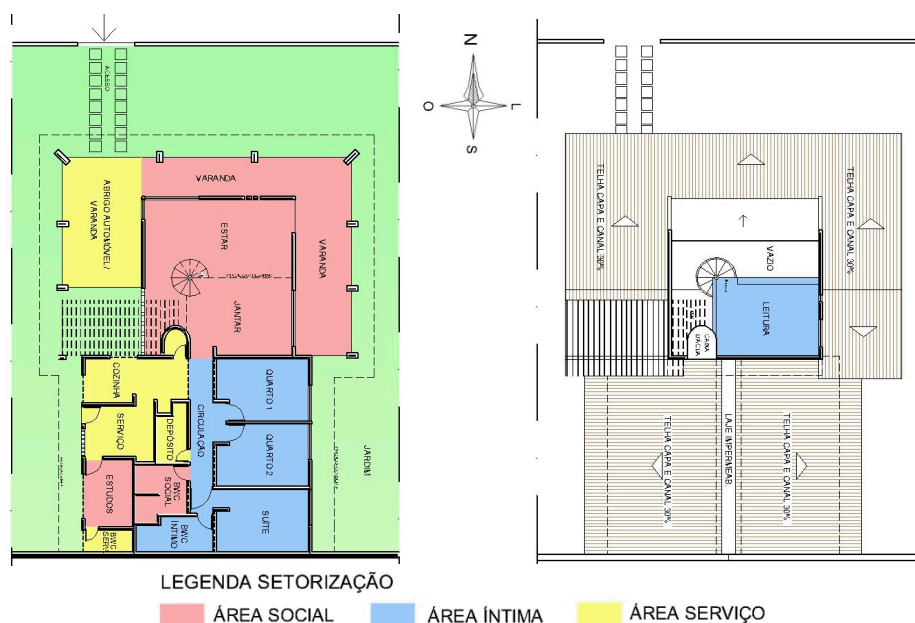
Plantas baixas dos pavimentos térreo e superior da casa, respectivamente
